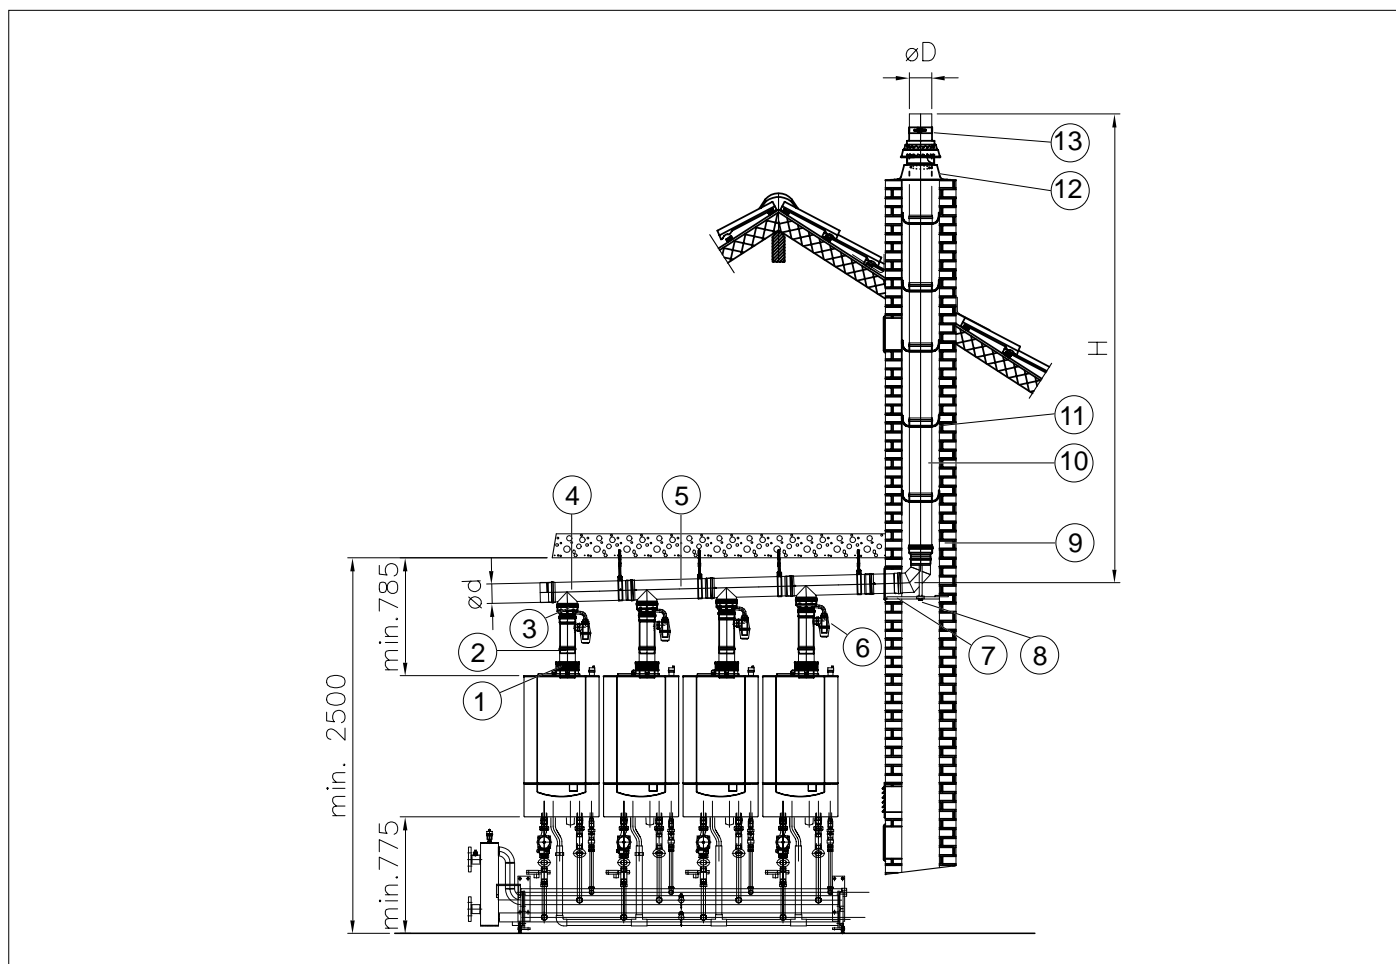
Überdruck Kaskadenabgassystem mit integrierter Rückschlagklappe für 2 bis 4 Remeha Quinta 45 / Quinta 65.
